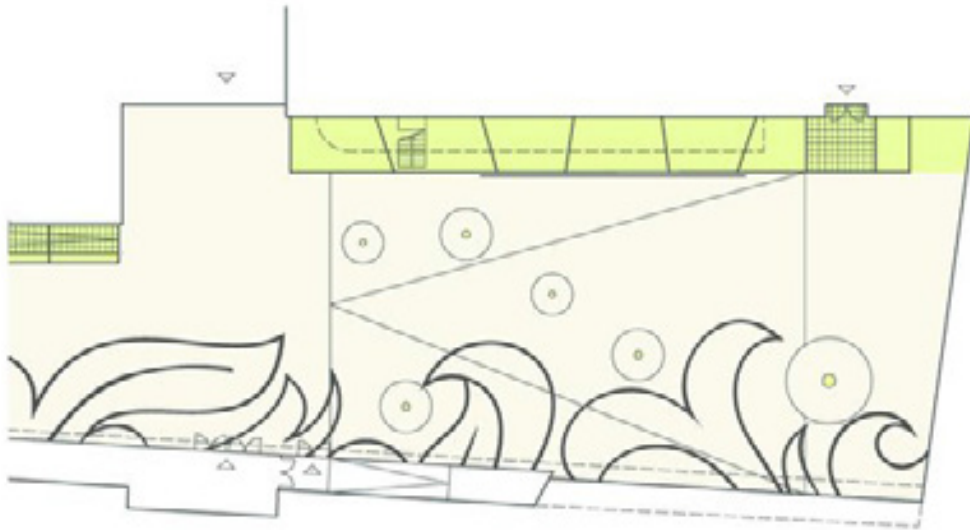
Freiraum HTL Spengergasse, Grundriss Entwurf
